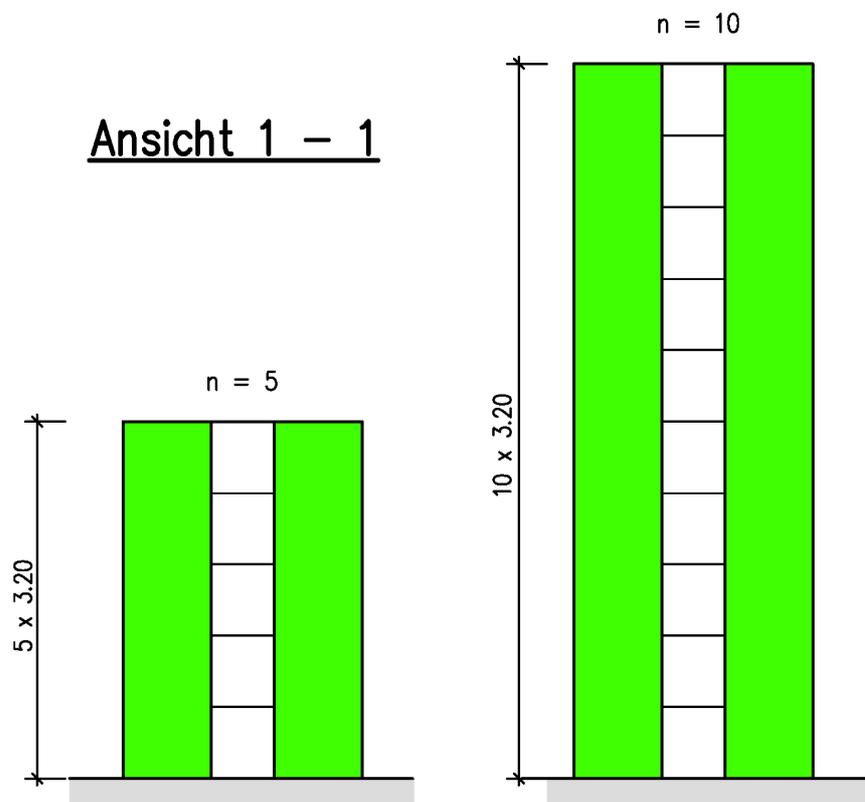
Mehrgeschossiges Bürogebäude – Ansicht
